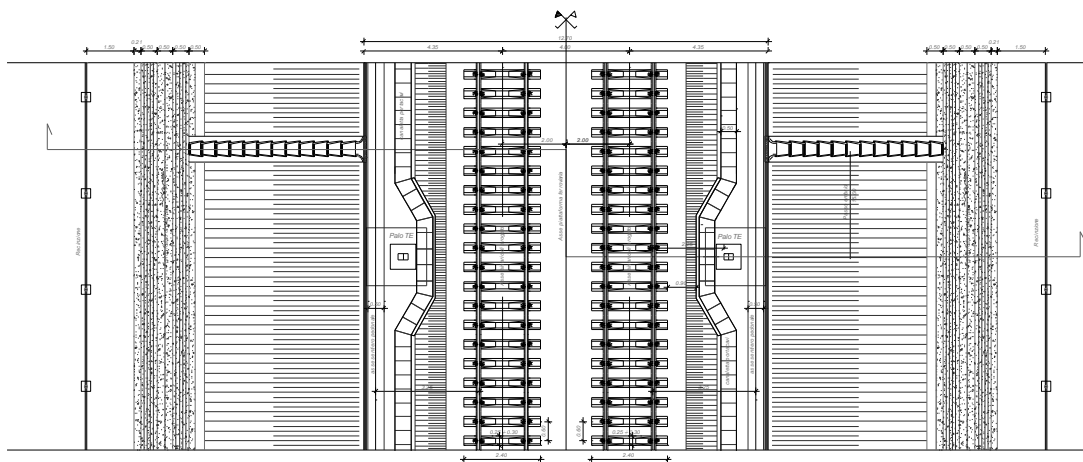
Stralcio planimetrico per sezione tipo ferroviaria in rilevato a doppio binario (piattaforma in retto) con $H_{ril} \leq 6,00$ m
